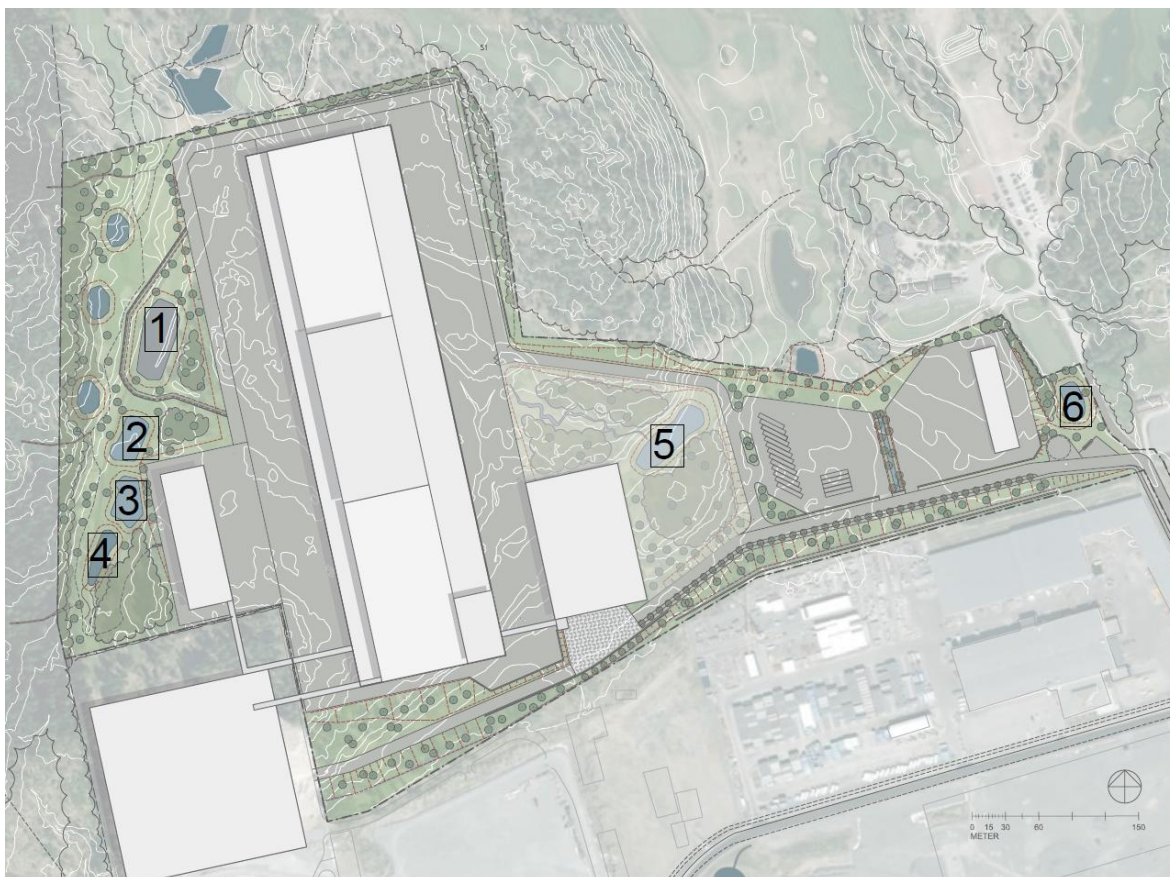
Ungefärlig lokalisering av installerade grundvattenrör inom planområdet. (FVB 2025, bakgrundsbild Archus, 2022).
